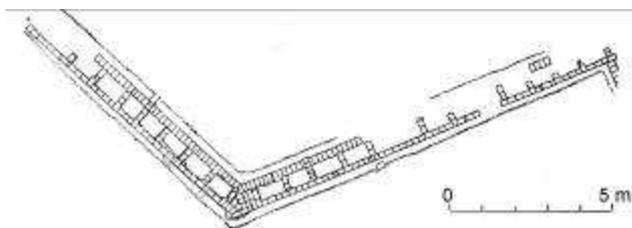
Volsinii* (Bolsena). Planimetria di un tratto delle mura a doppia cortina, in località Giardino (H. Bloch in LUGLI 1957)
